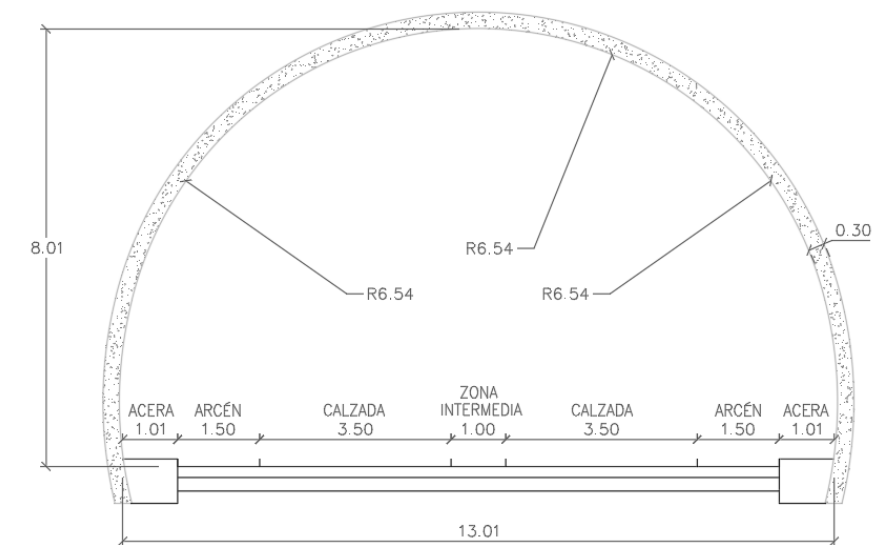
Sección transversal de túnel para la segunda alternativa.
